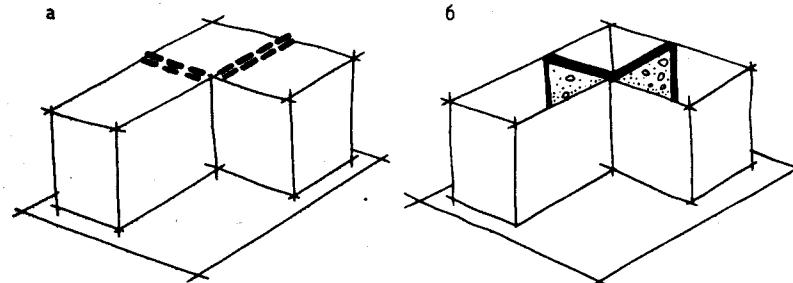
Решение конструктивной схемы U-образного в плане здания Парк Роу, Нью-Йорк, рассчитанного на сопротивление ветровым нагрузкам
